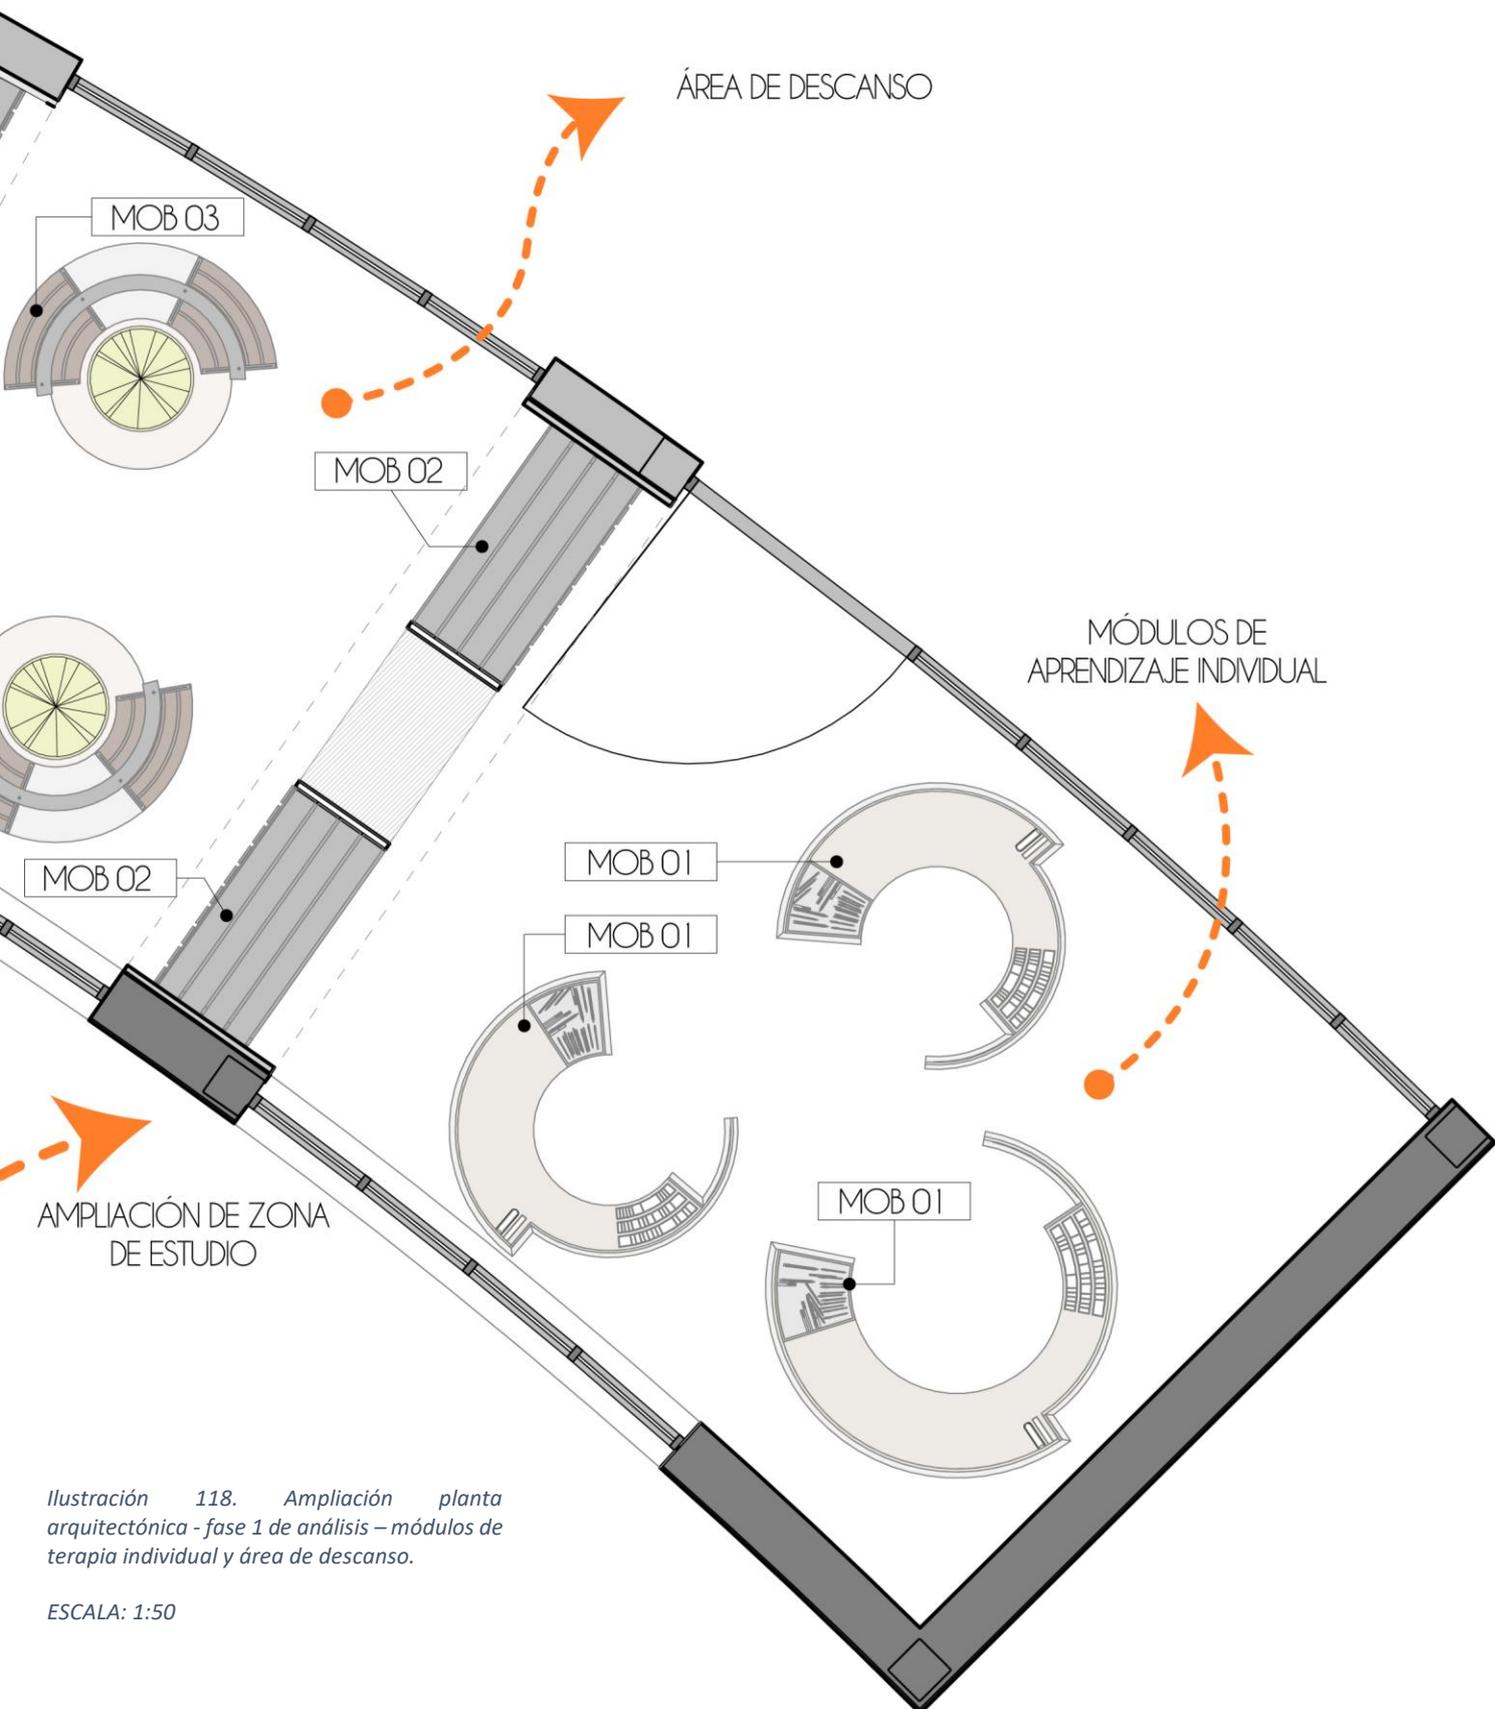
Ampliación planta arquitectónica - fase 1 de análisis - módulos de terapia individual y área de descanso.
